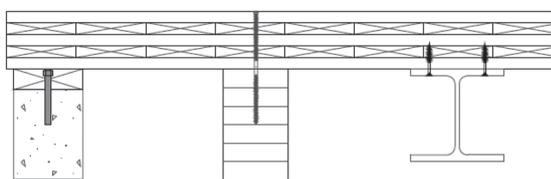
Appuis usuels de plancher sur support bois, métallique ou béton
